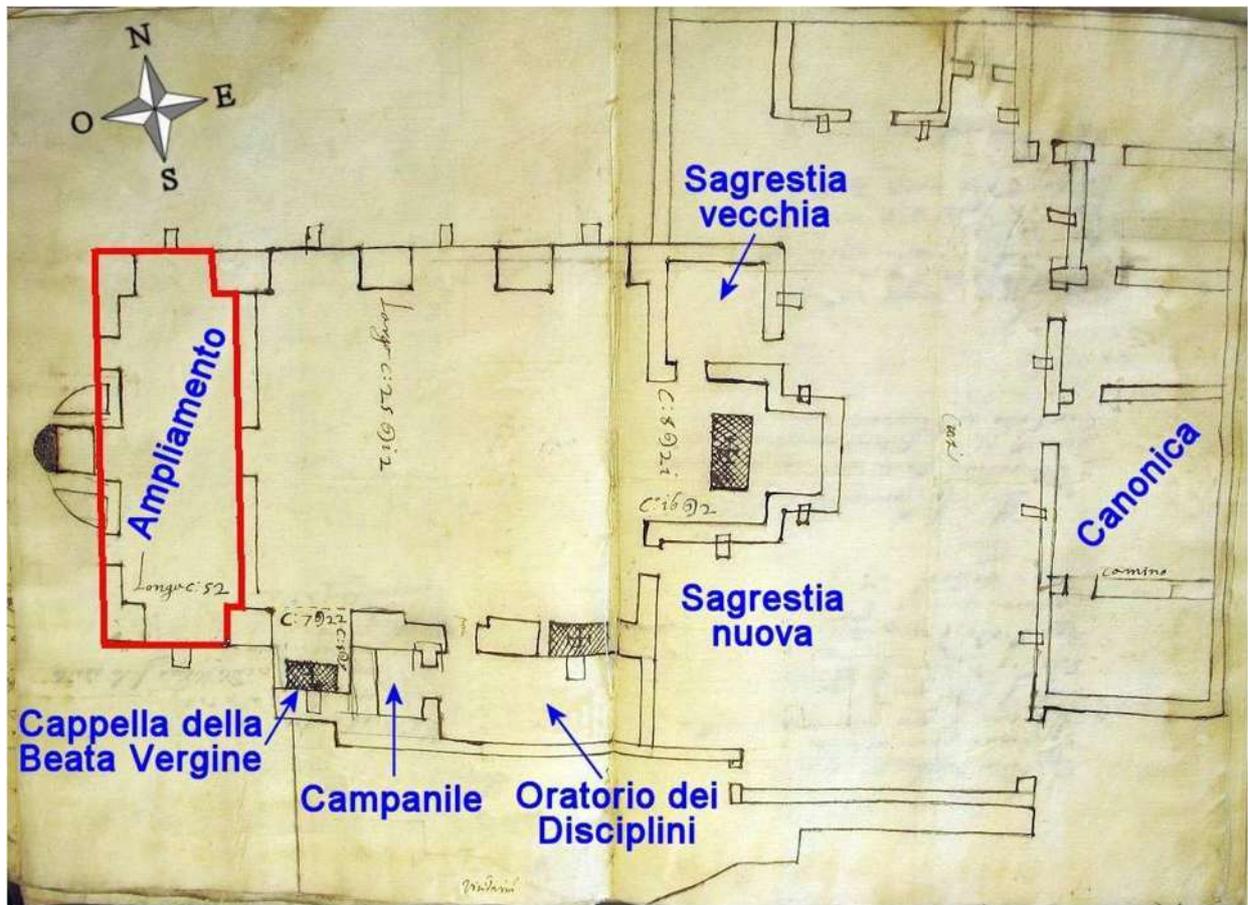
Planimetria dell'ampliamento della chiesa parrocchiale di Inzago
